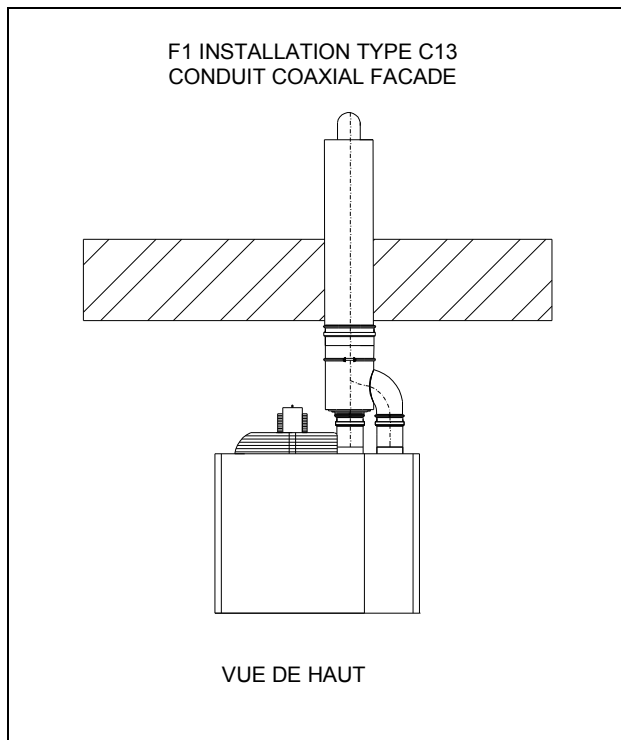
INSTAL.TYPE C13 CONDUIT COAXIAL FACADE
